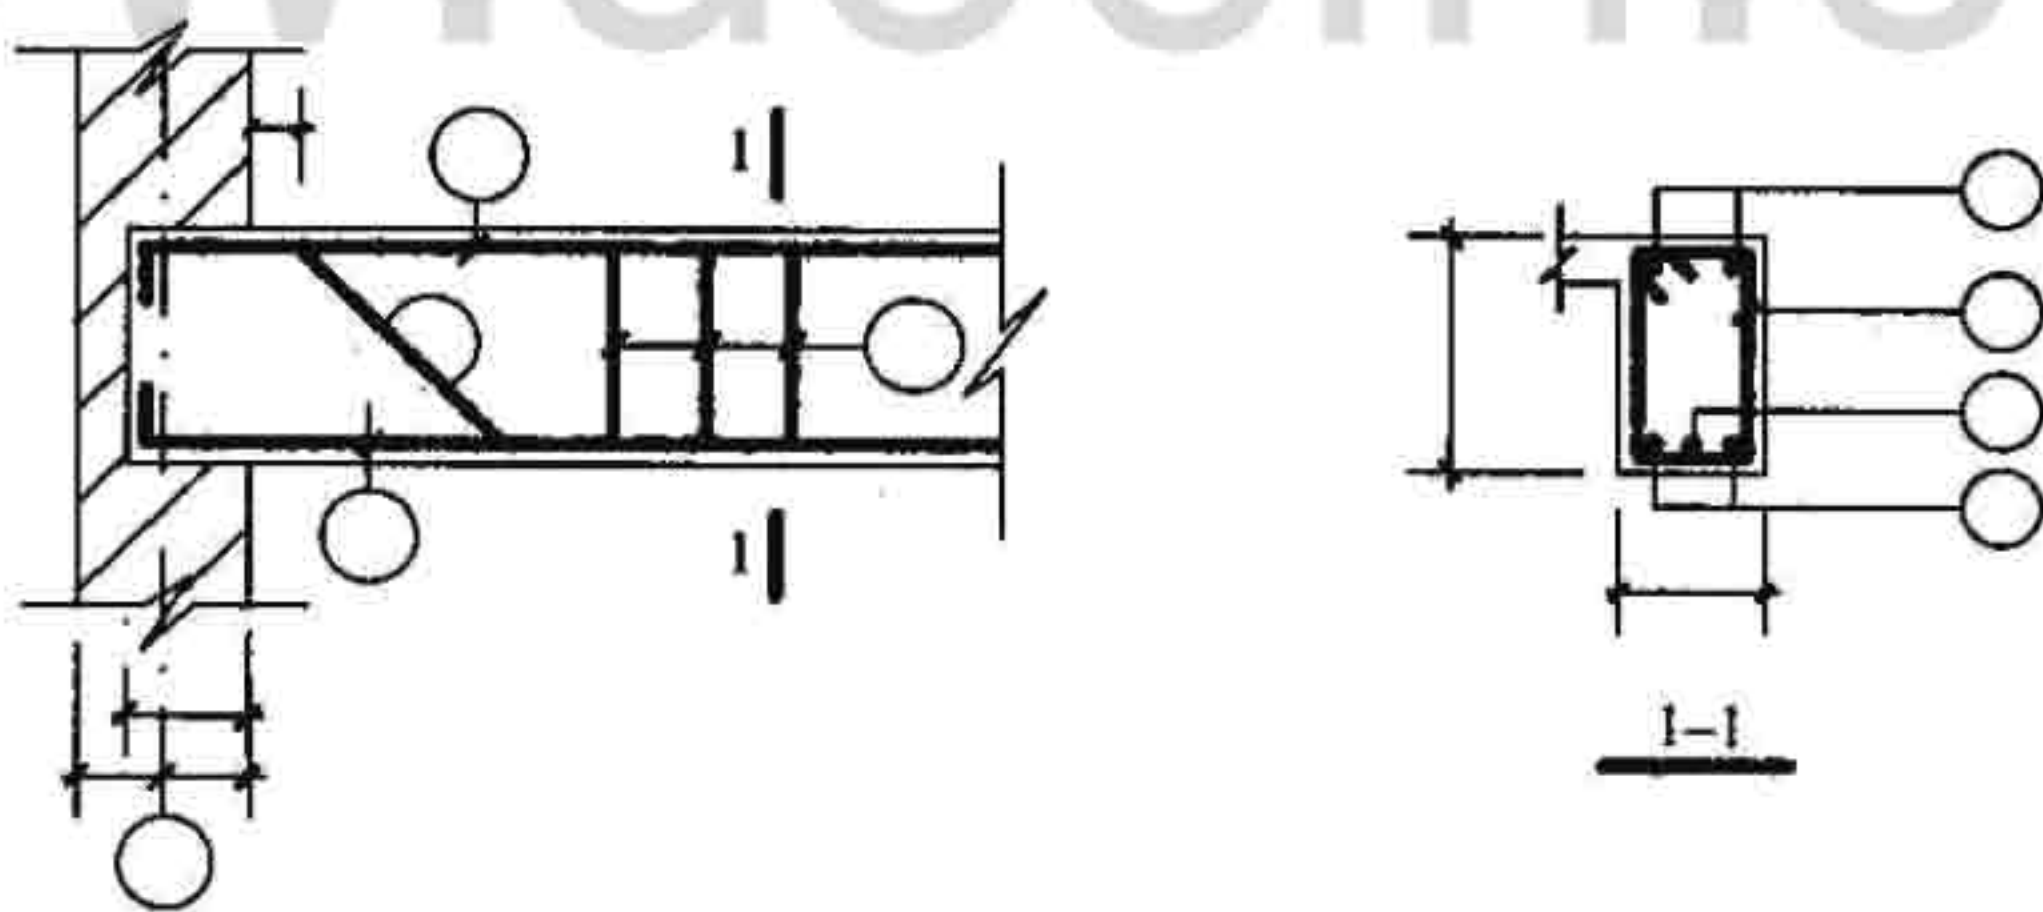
梁纵、横断面图中钢筋表示方法
